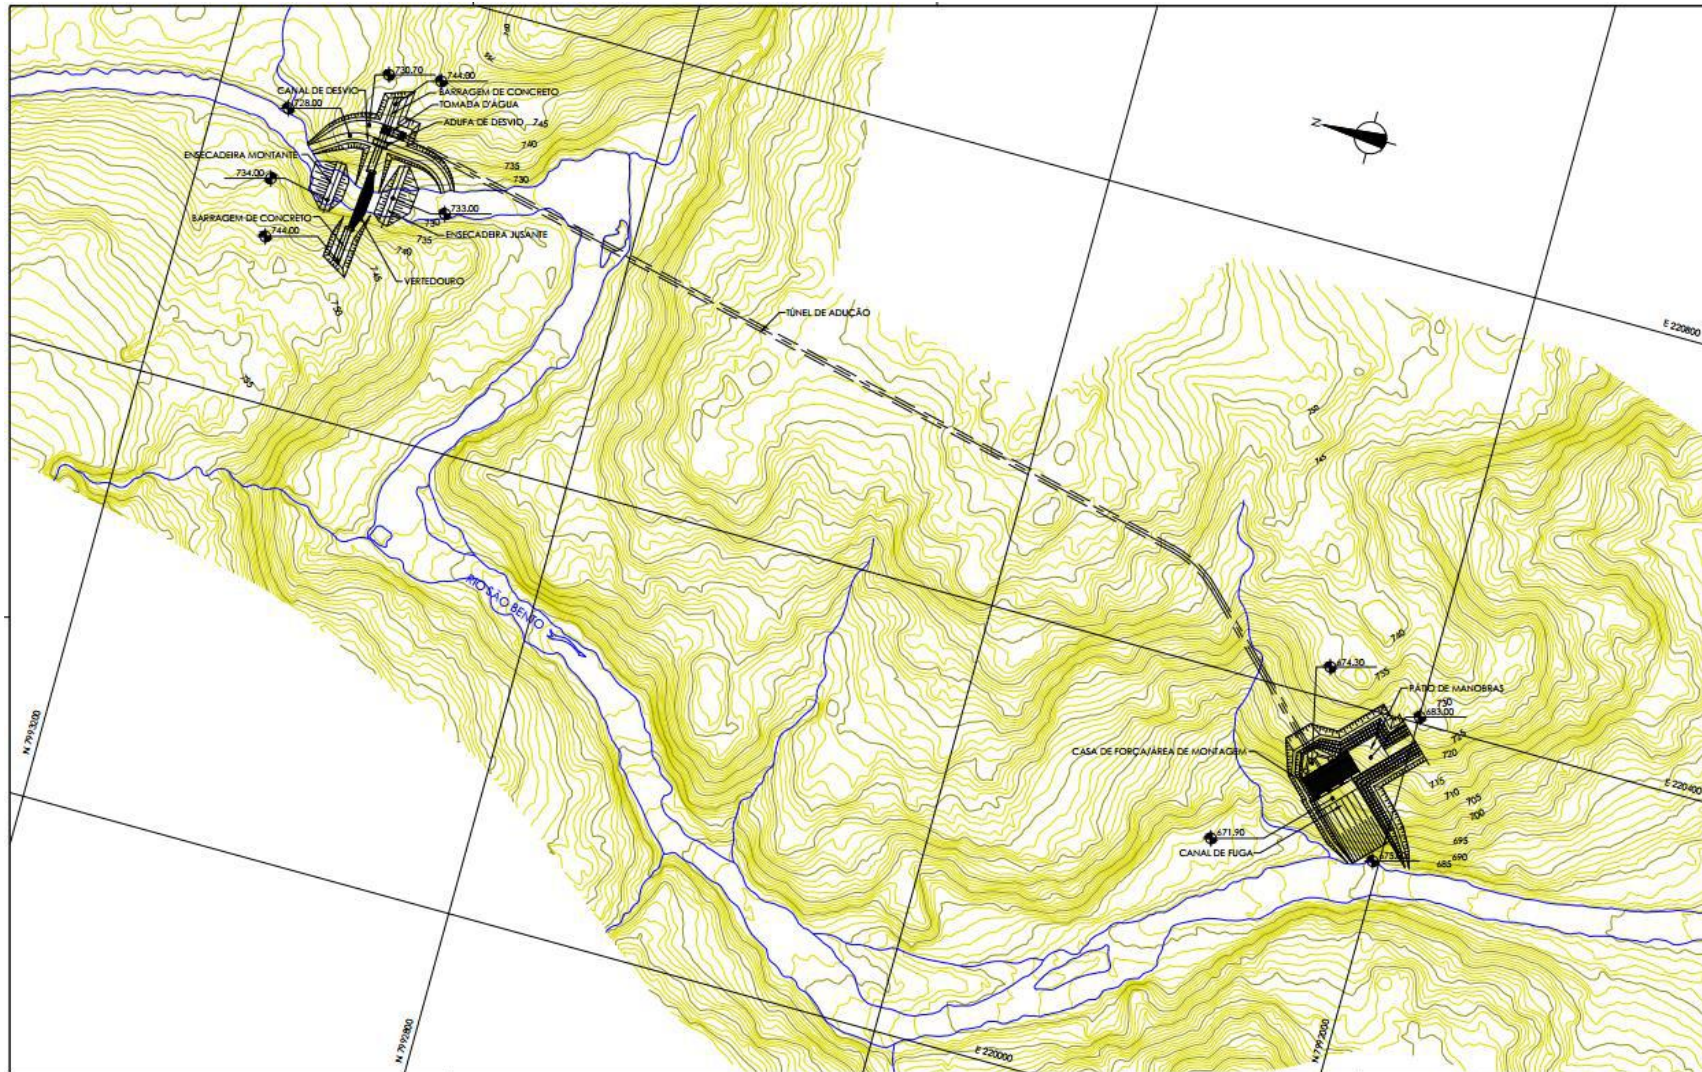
Arranjo geral das estruturas – Alternativa 3
